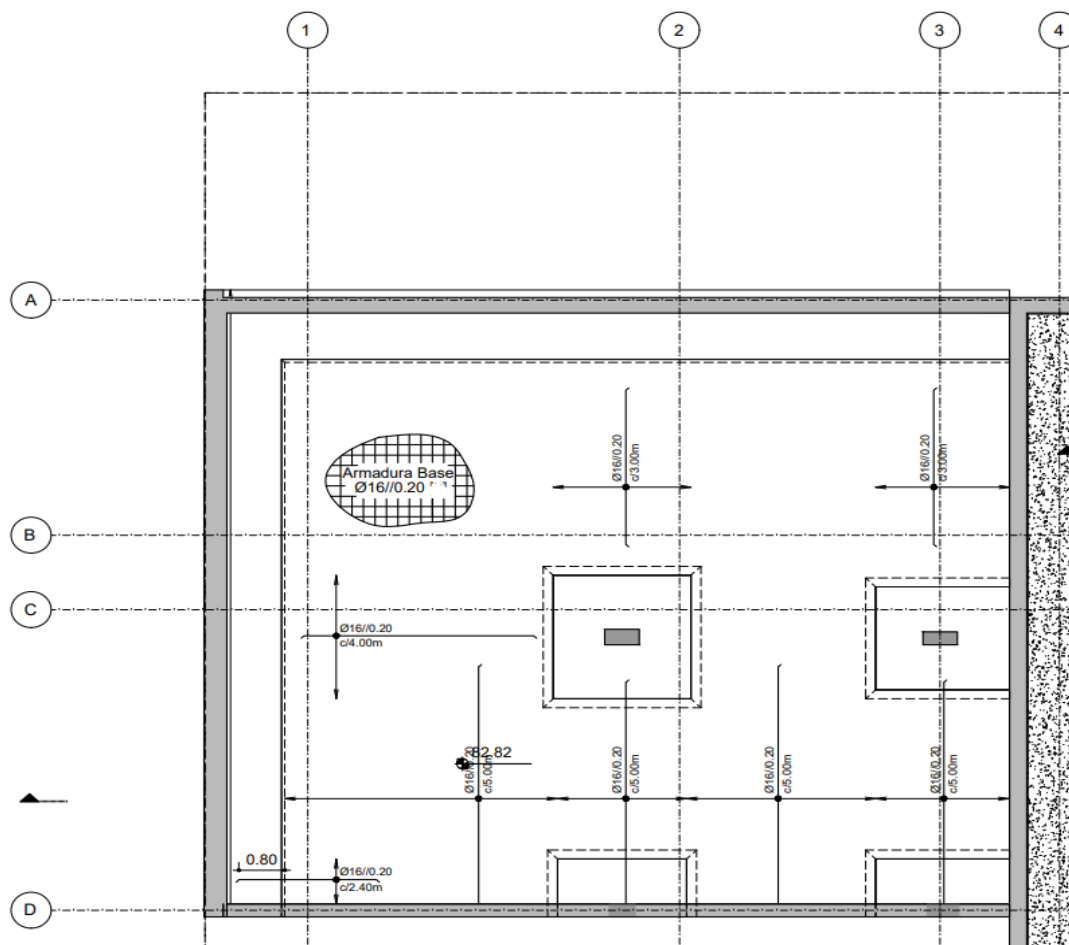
Planta de armadura superior do ensoleiramento.
